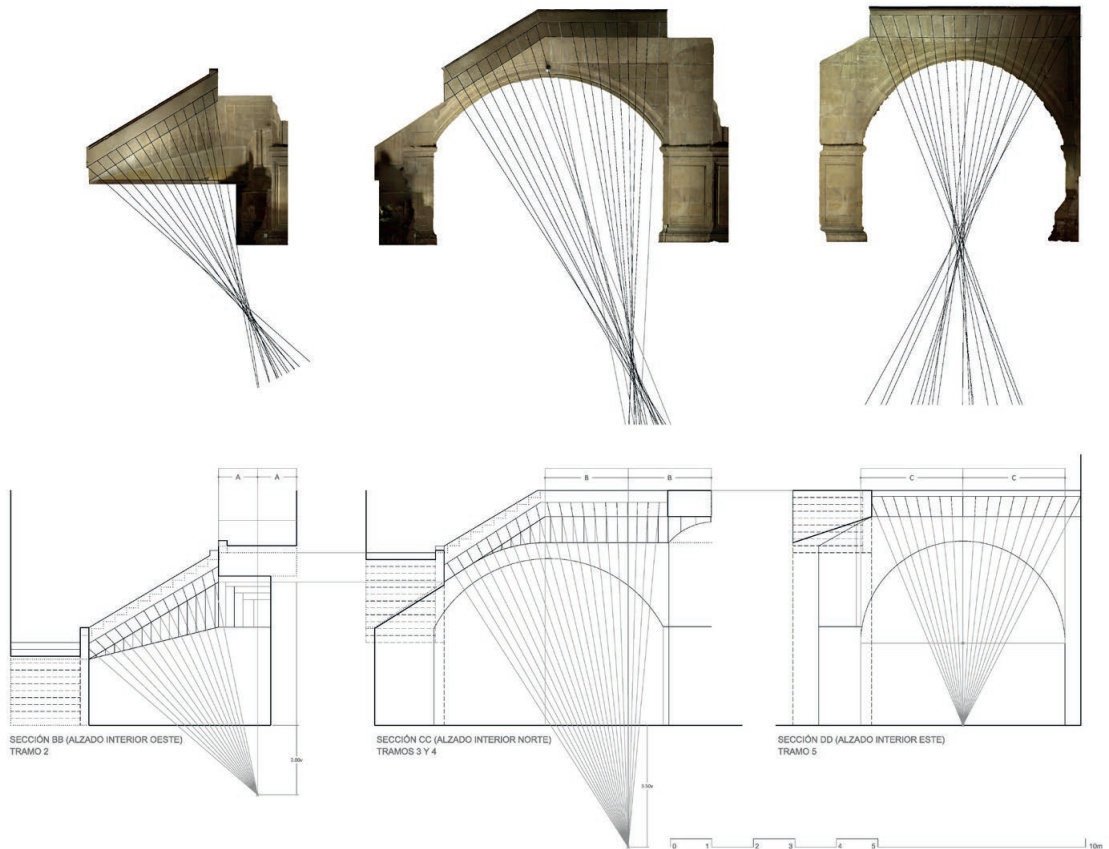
Hipótesis de trazado de los alzados interiores en base a las ortoimágenes del levantamiento con las juntas prolongadas (imagen de los autores).
